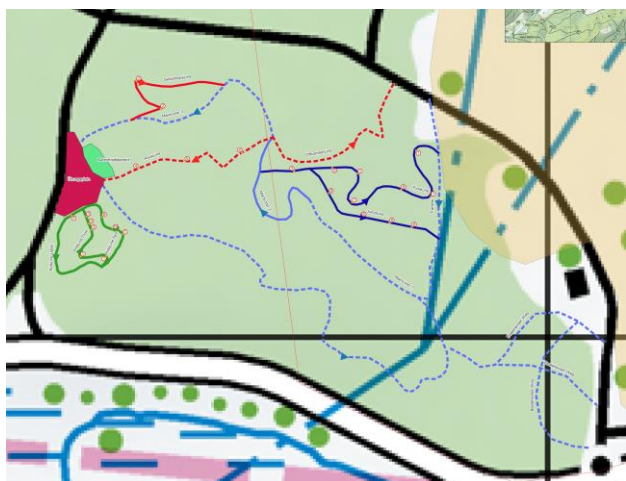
Ausschnitt aus dem Ausführungsplan «Trailcenter Bonaduz» (Darstellung Allegra Trails GmbH)
